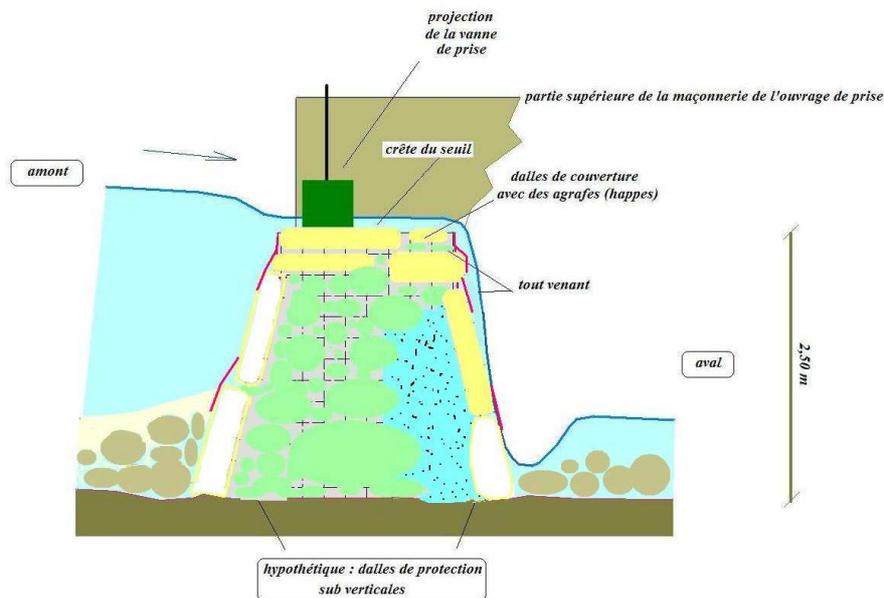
le profil d'une rive à l'autre et les sections transversales du seuil avant sa destruction (hypothèses)
